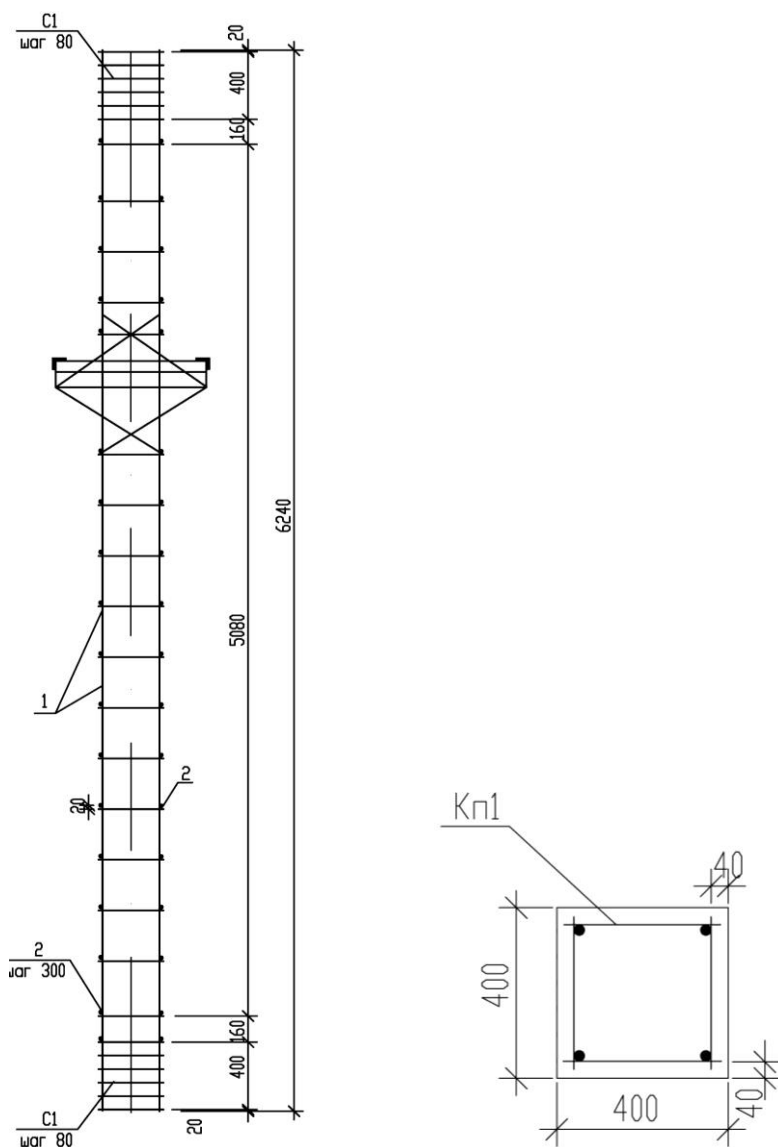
Продольное и поперечное армирование железобетонной колонны
